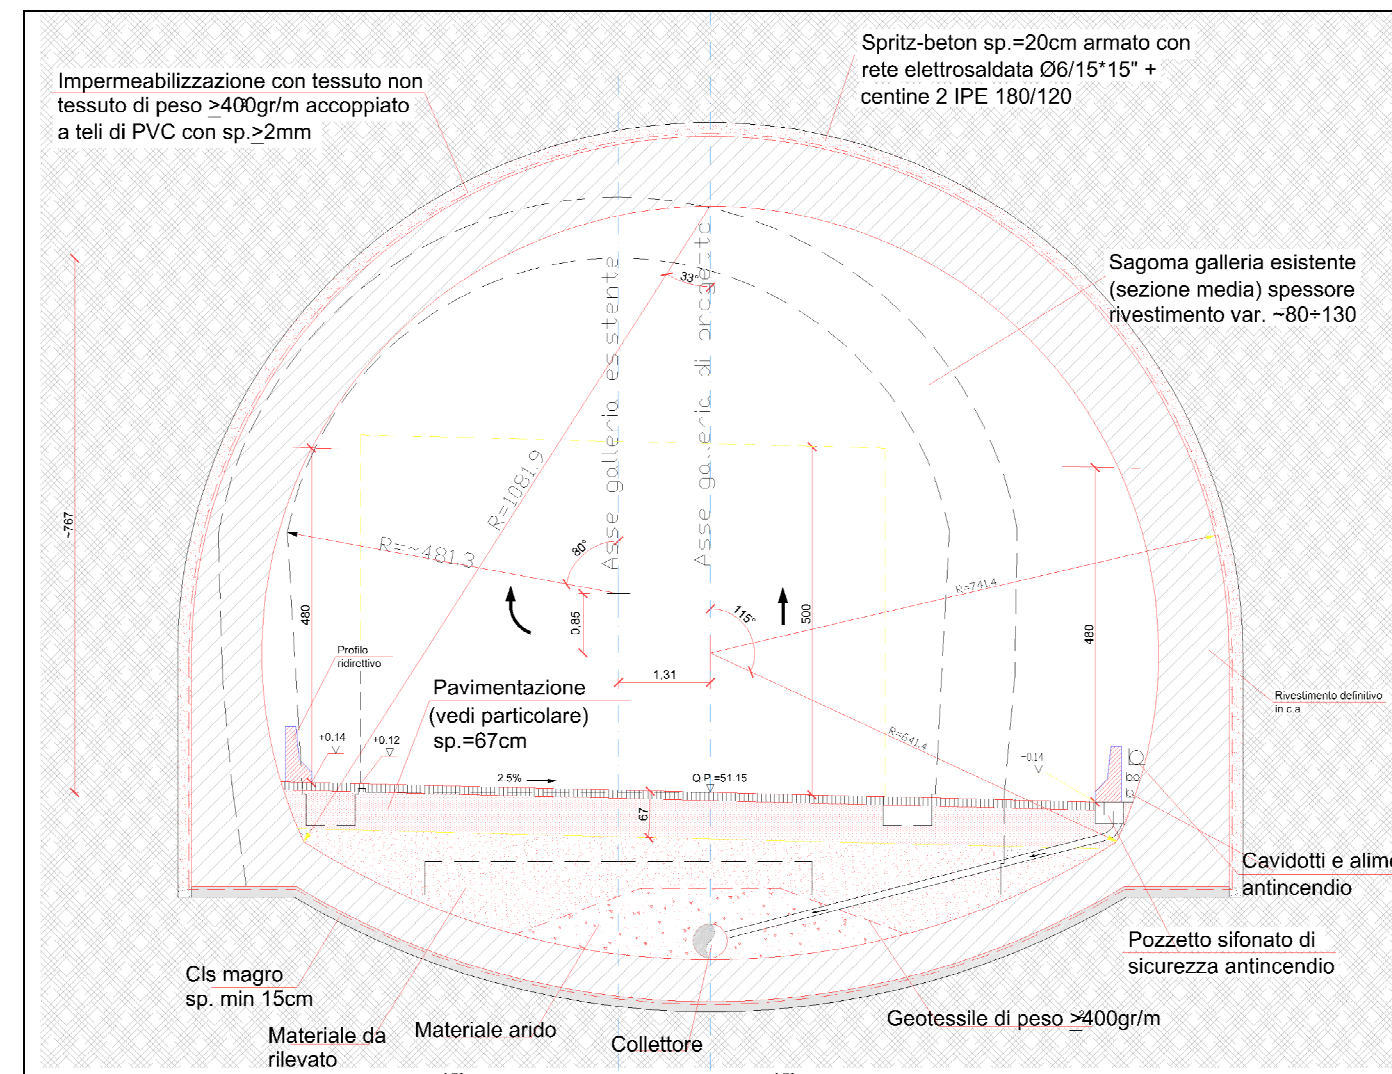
Sezione tipo trasversale della galleria –lato dx
